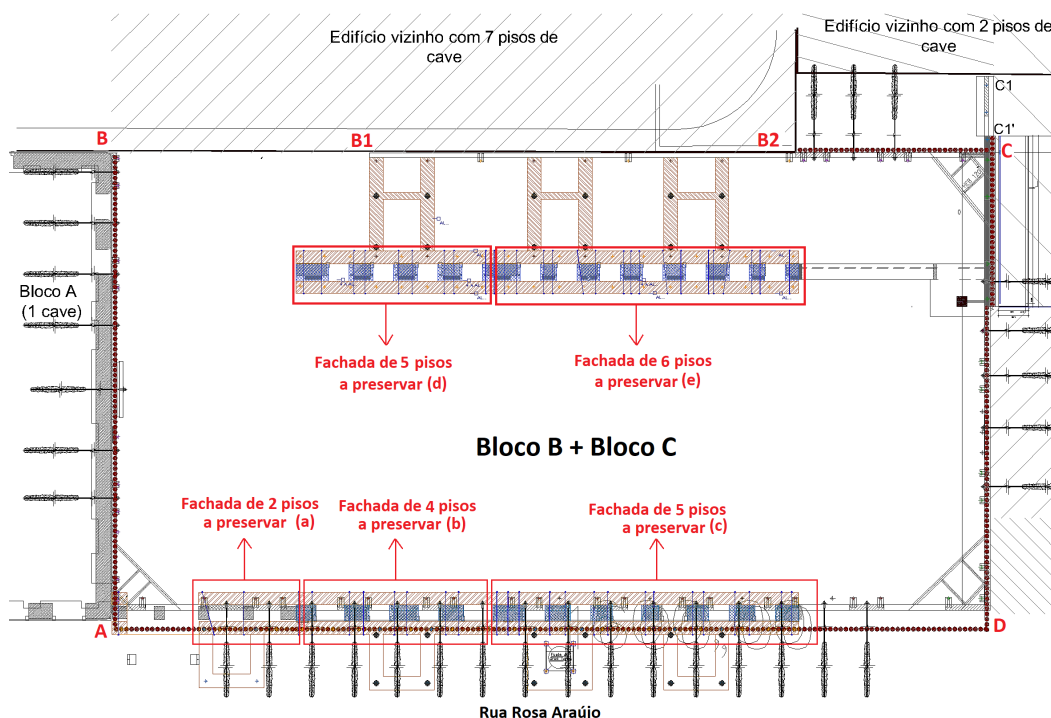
Planta de implantação: Liberdade 203. Adaptado de [14]
